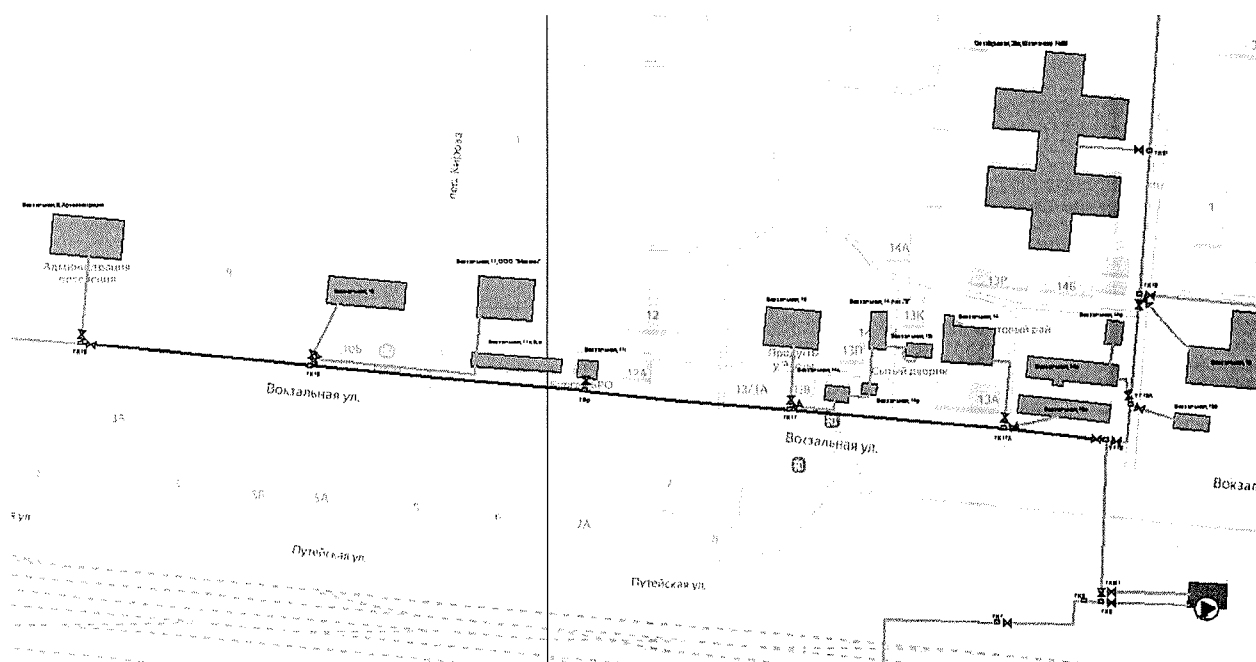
Трубопроводы, перекрытые для проведения ремонтных работ.
